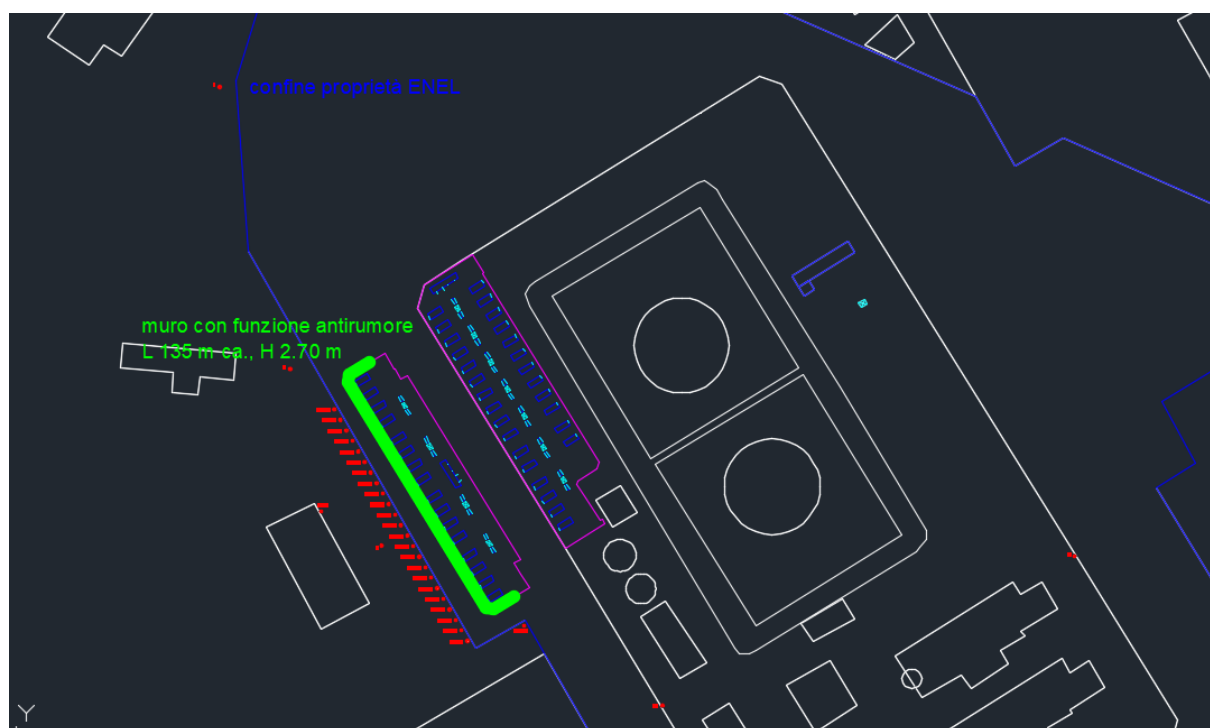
Dettaglio muro con funzione antirumore in aggiunta al muro di cinta esistente
